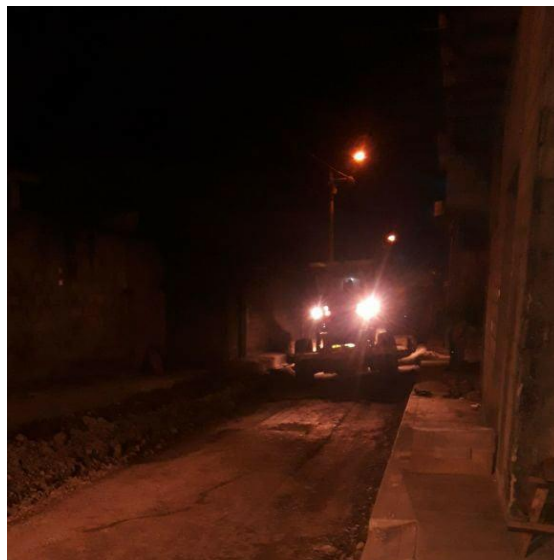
Abastecimiento de material de préstamo para la conformación de la Base – pavimento en el Pasaje Los Cedros, AA.HH. La Playa.
